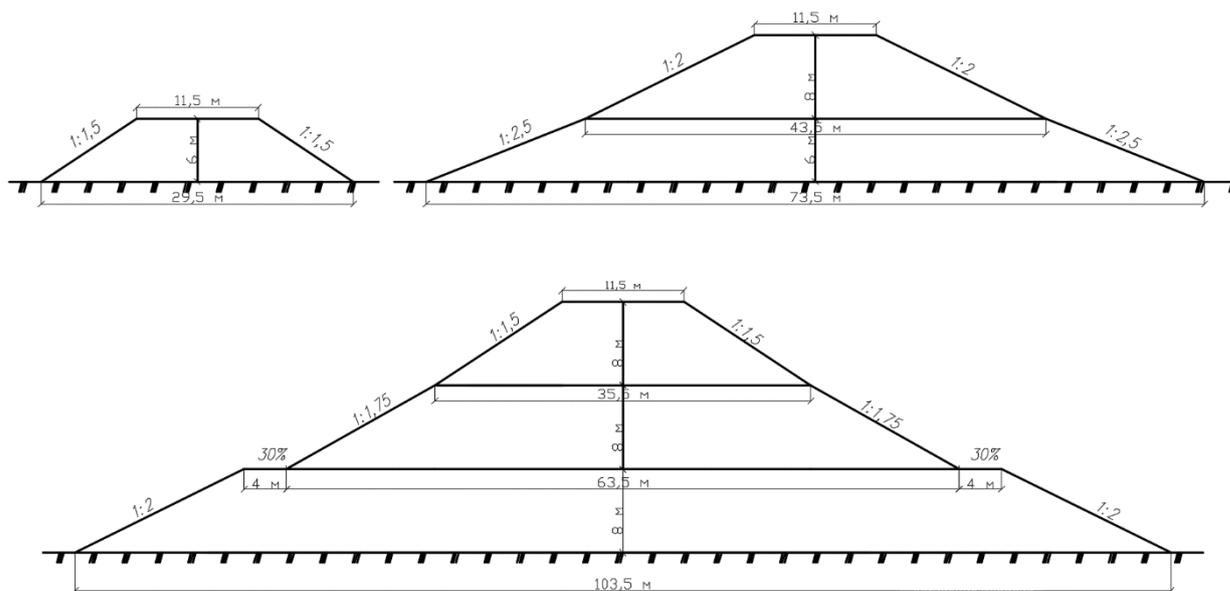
Поперечные профили насыпи подхода к мосту с высотой до 6, 14 и свыше 16 метров.
